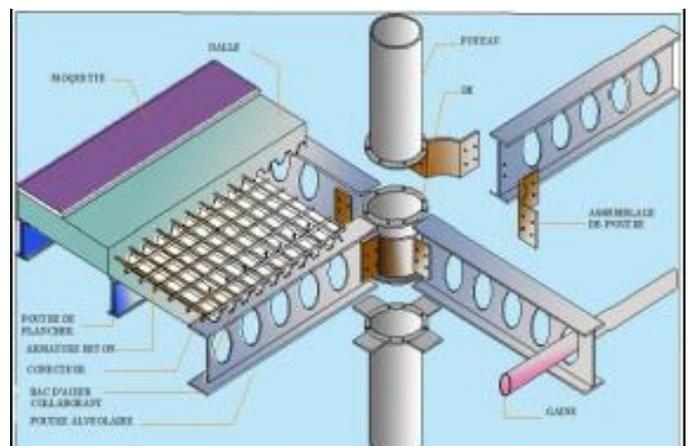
Détails de la combinaison d'une poutre alvéolaire avec un plancher collaborant
